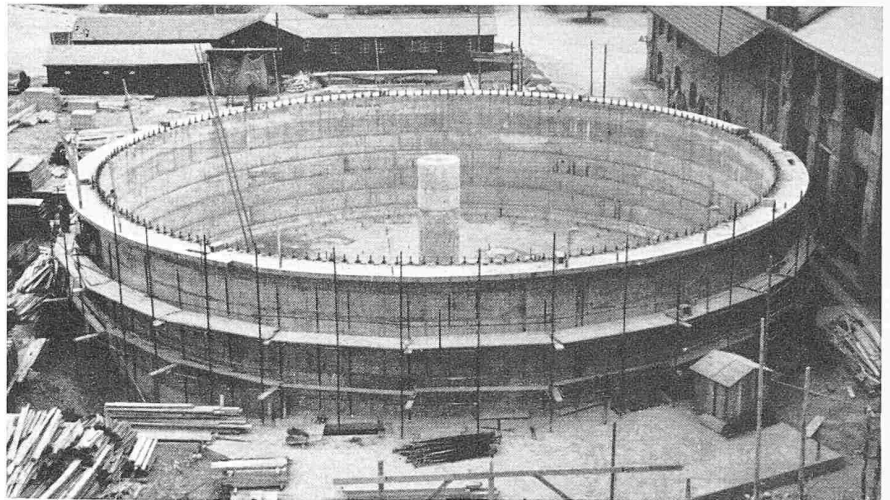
Gerüstung für Behälterwand; Betonieretappen deutlich erkennbar
